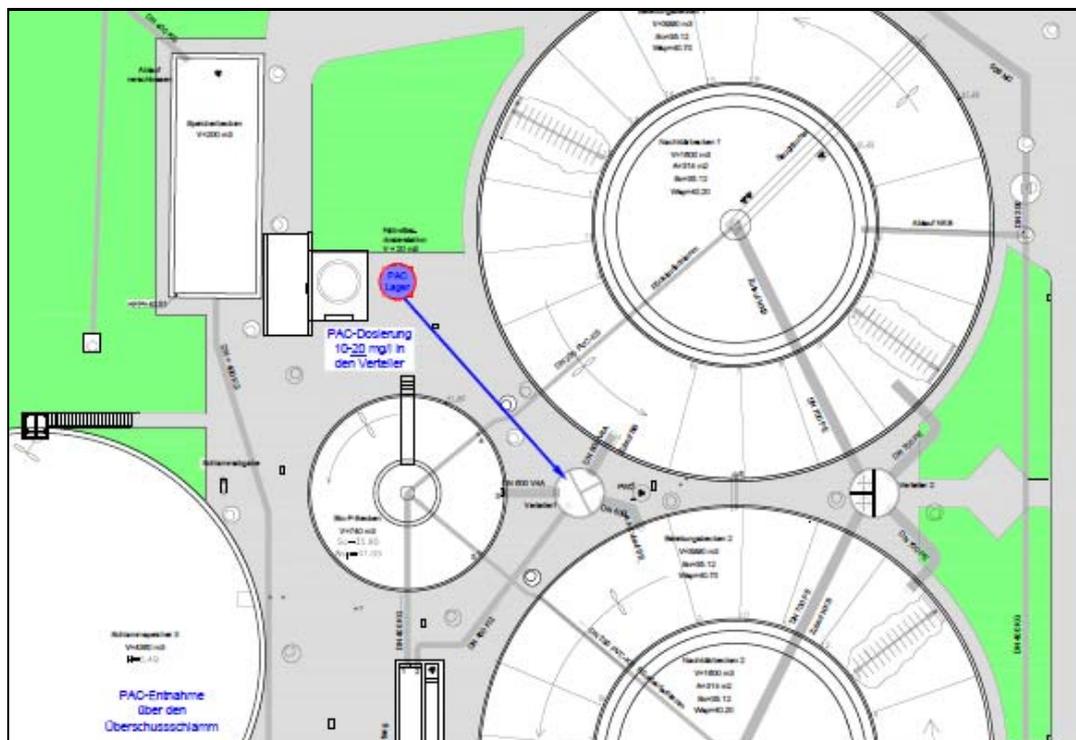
Lageplan KA Rahden West - Variante 1.1 – PAK Dosierung in die Belebung
